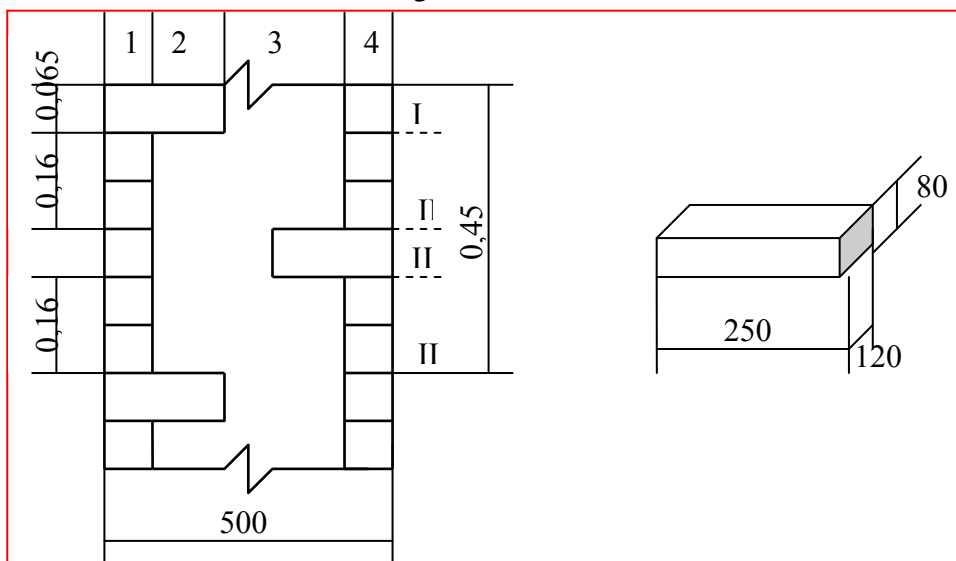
Расчетное поперечное сечение конструкции стены
